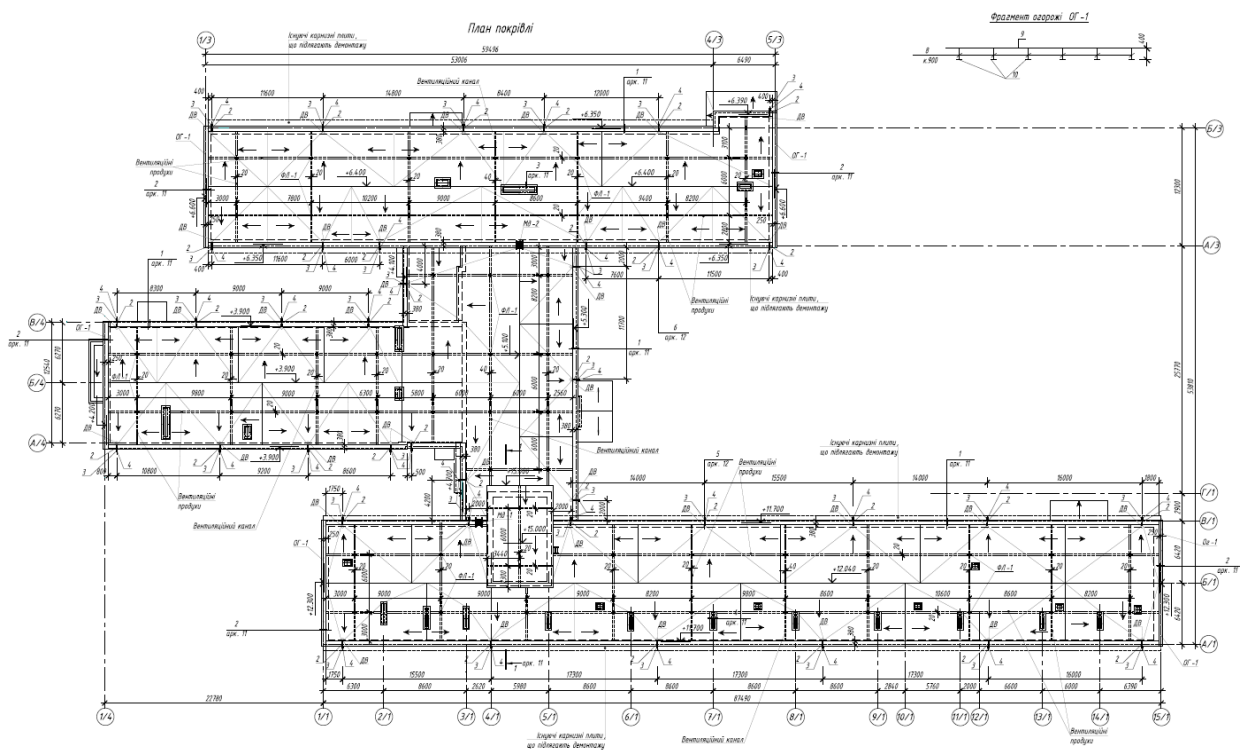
План покрівлі будівлі загальноосвітнього навчального закладу (отримано із архівних матеріалів робочого проекту).
